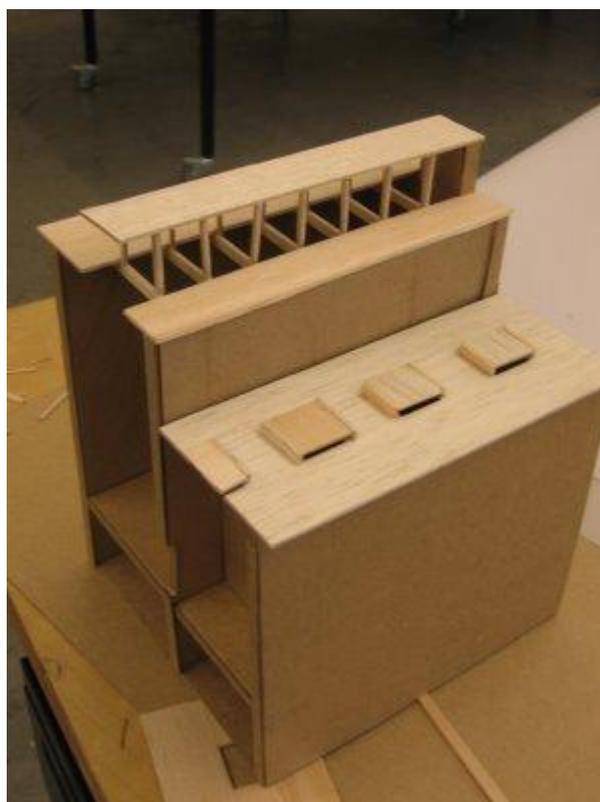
Maquete de Detalhe da Estrutura
